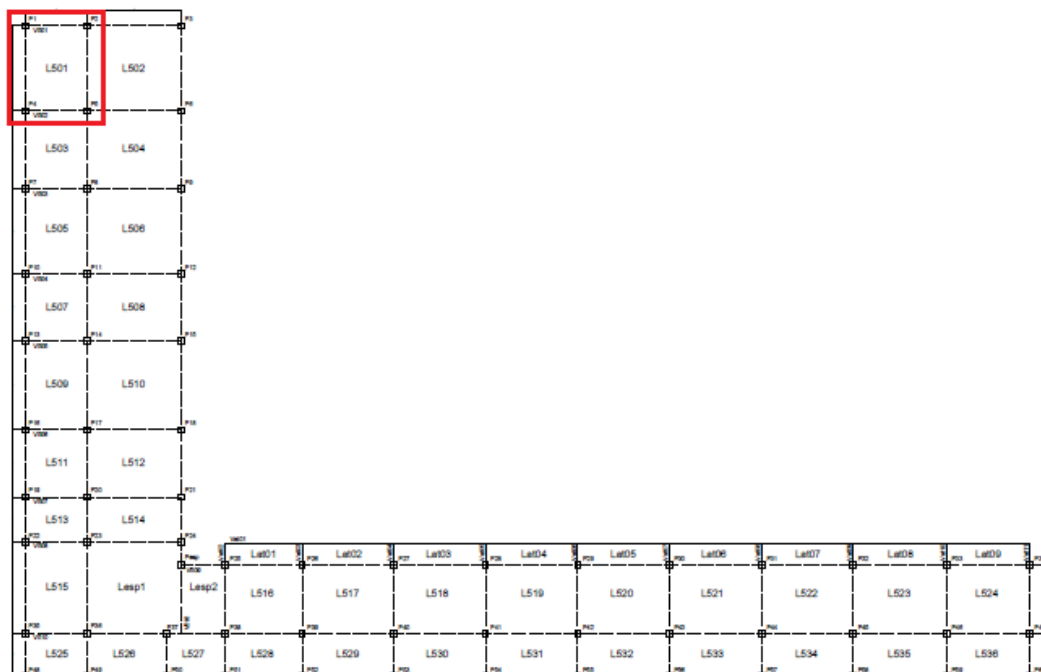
Laje L501 - Laje 501 demarcada em vermelho para exemplificar o cálculo da armação da laje. – Fonte: Projeto executivo baseado no projeto real.
